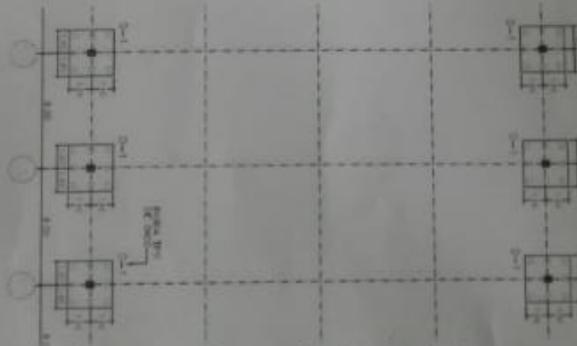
Planta de zonas para anexo del formato de llenos.
